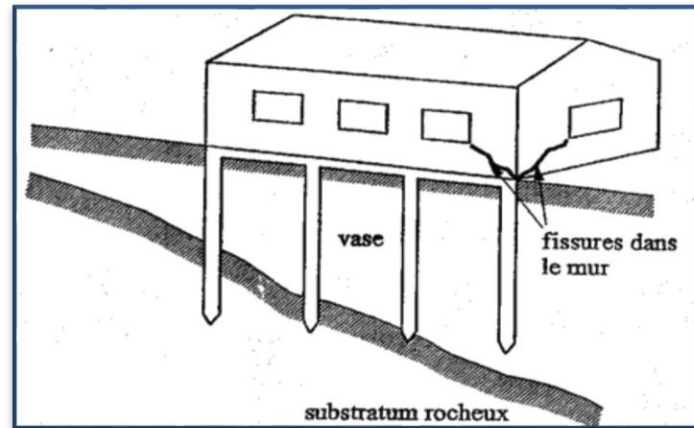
Construction est fissurée car les pieux d'angle n'ont pas atteint substratum rocheux. [10]
